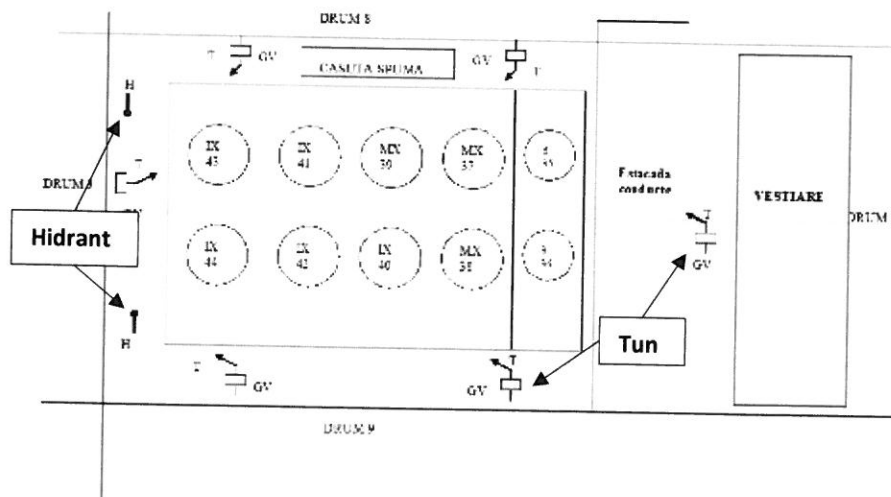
Schema de amplasare a instalațiilor de stingere (OB 343)
